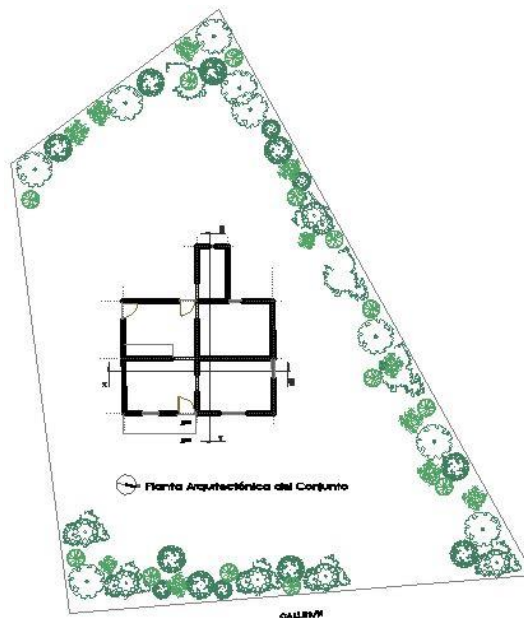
Planta Arquitectónica del Conjunto. Fuente: Elaboración propia.
